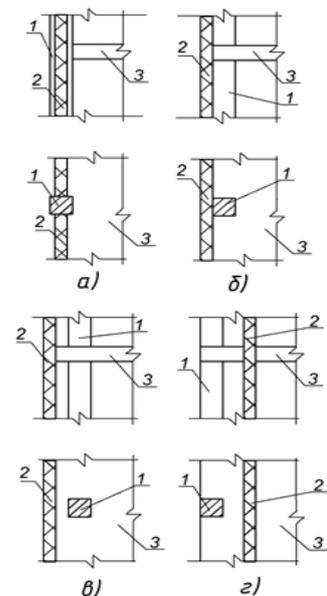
Варіанти розташування зовнішніх стін відносно колон: а – в одній площині; б – біля колони; в – на зовні будівлі; г – в середині будівлі; 1 – колона; 2 – зовнішня стіна; 3 – перекриття
